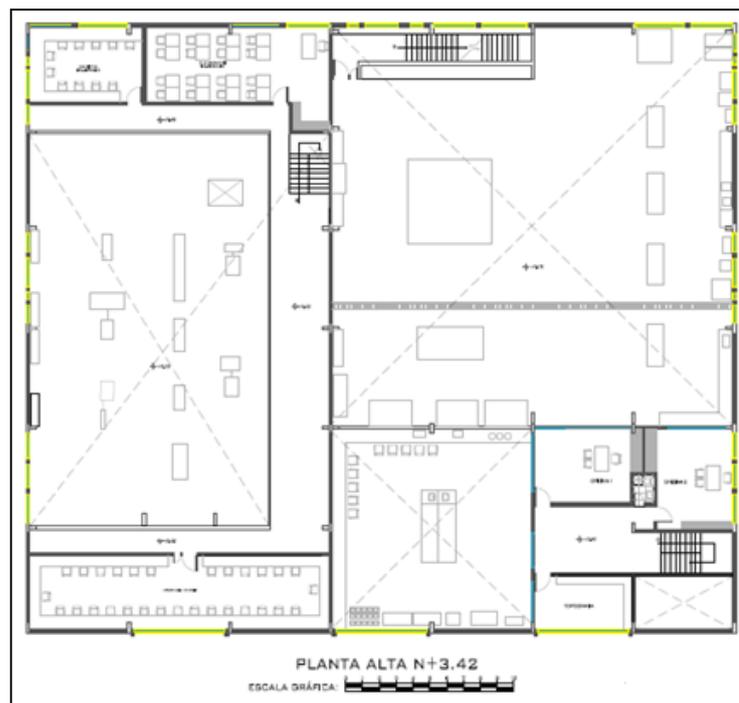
Planta Arquitectónica Alta de la carrera de ingeniería civil
